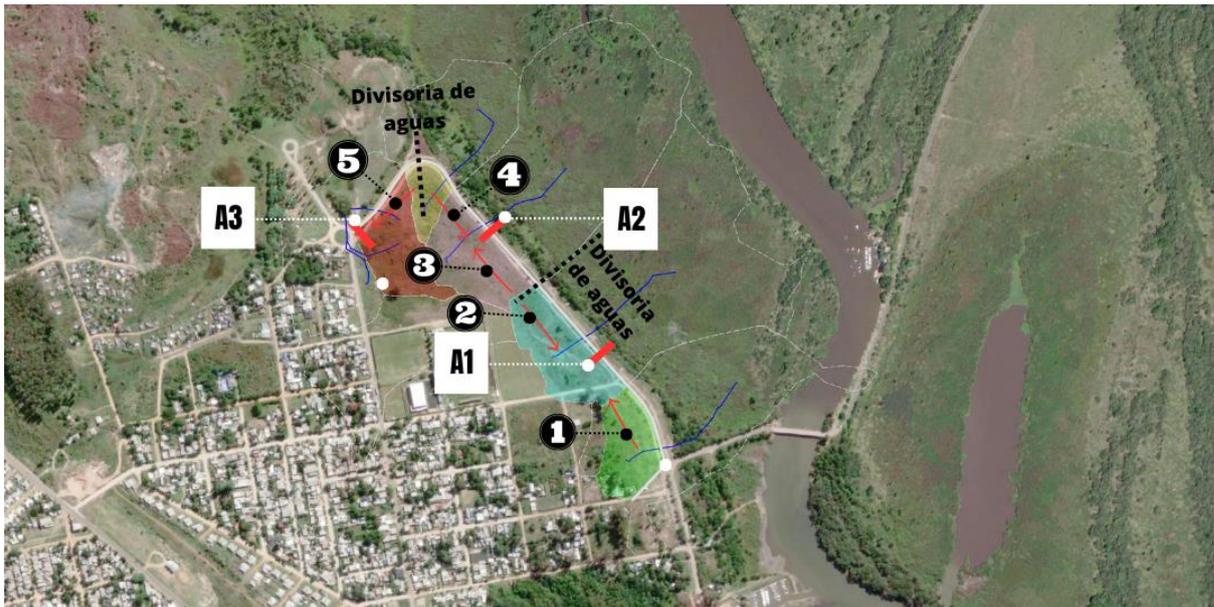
Anteproyecto hidráulico: drenaje – ubicación de alcantarillas y tramos.
